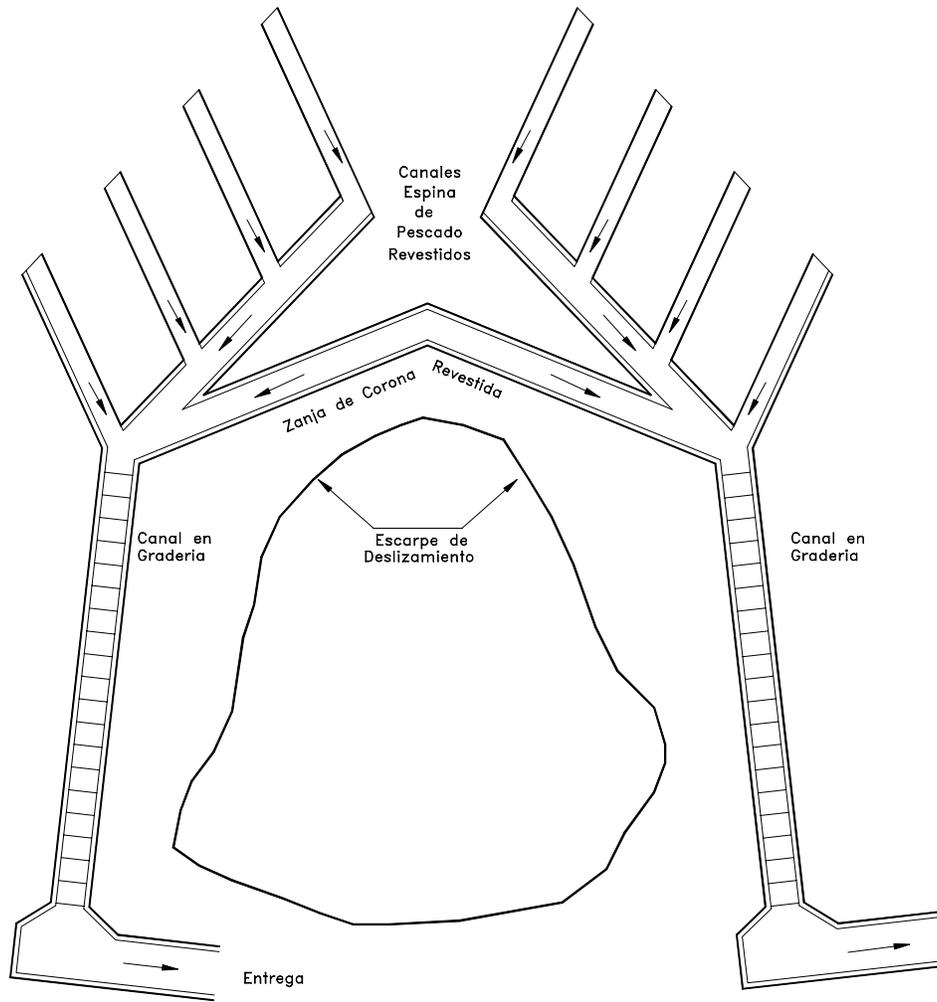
Esquema en planta de canales colectores espina de pescado
